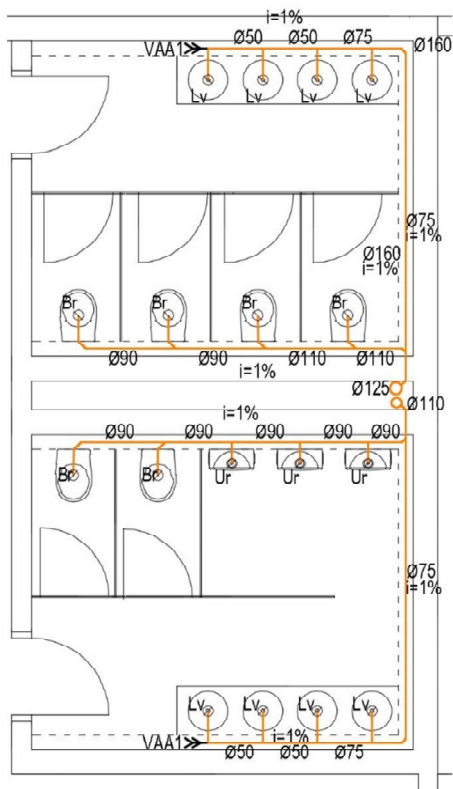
Planta da rede de drenagem do 3º, 4º, 5º, 6º e 7º piso
